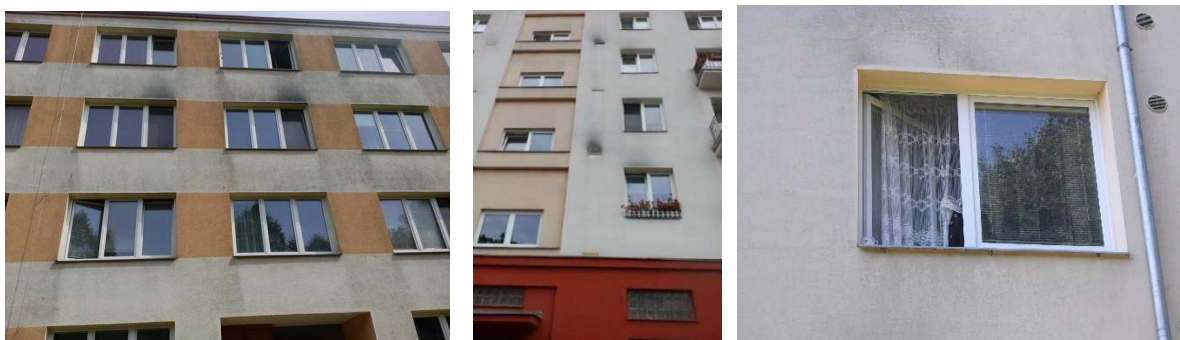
10: Příklady a důsledky špatně odizolovaného parapetního oplechování.
